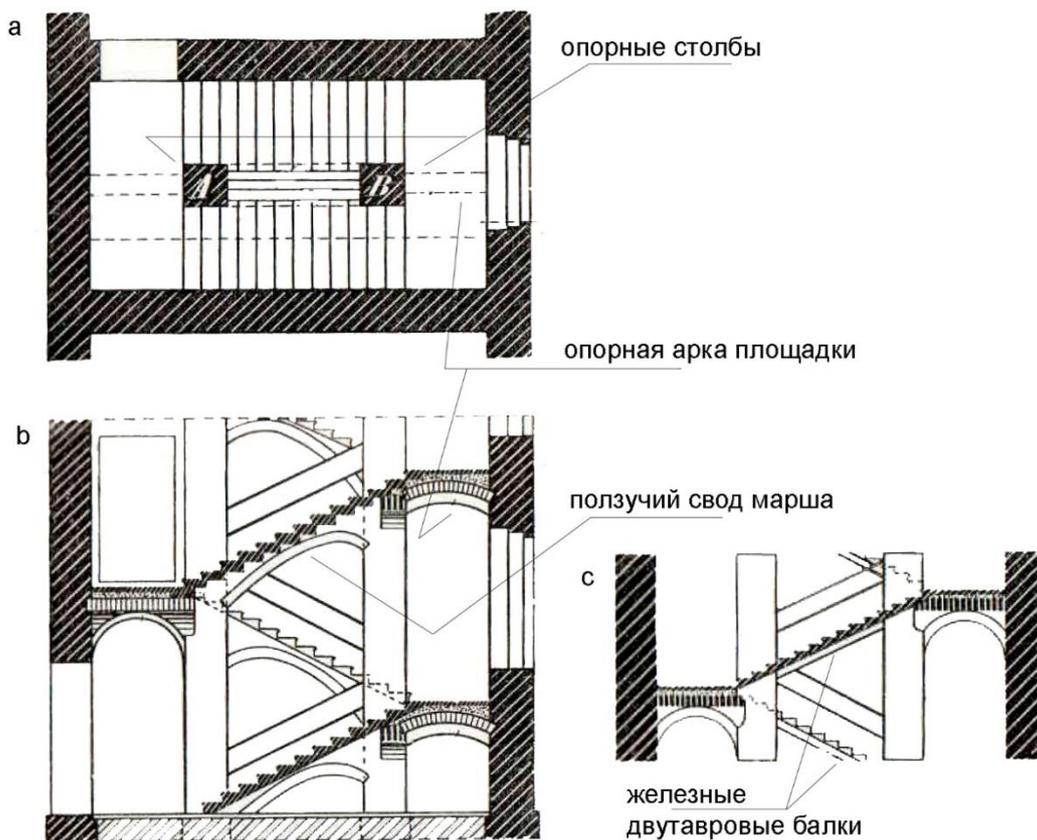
Лестница на столбах с арочно-сводчатыми конструкциями площадок: а – план; б – продольный разрез с маршами на ползучих сводах; с – продольный разрез с маршами на железных балках [33]
